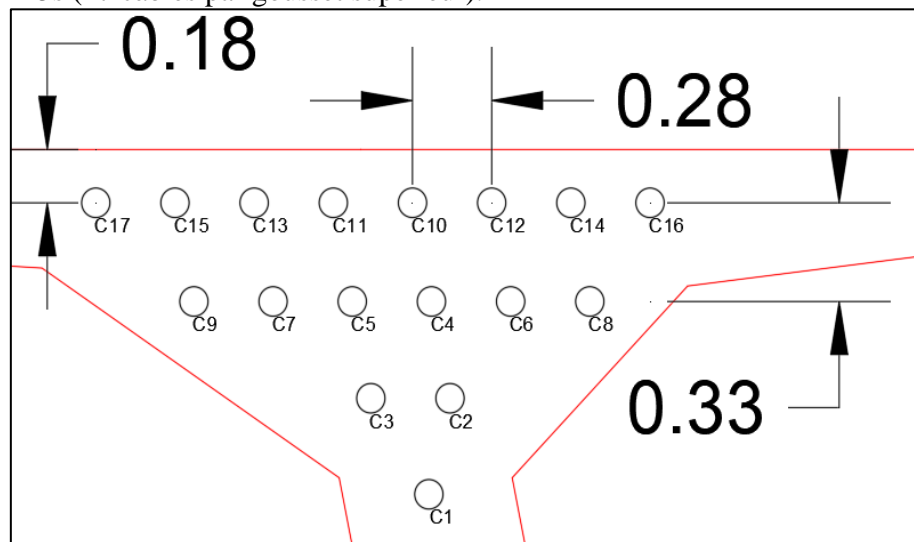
Dispositions des câbles au niveau du voussoir sur pile
